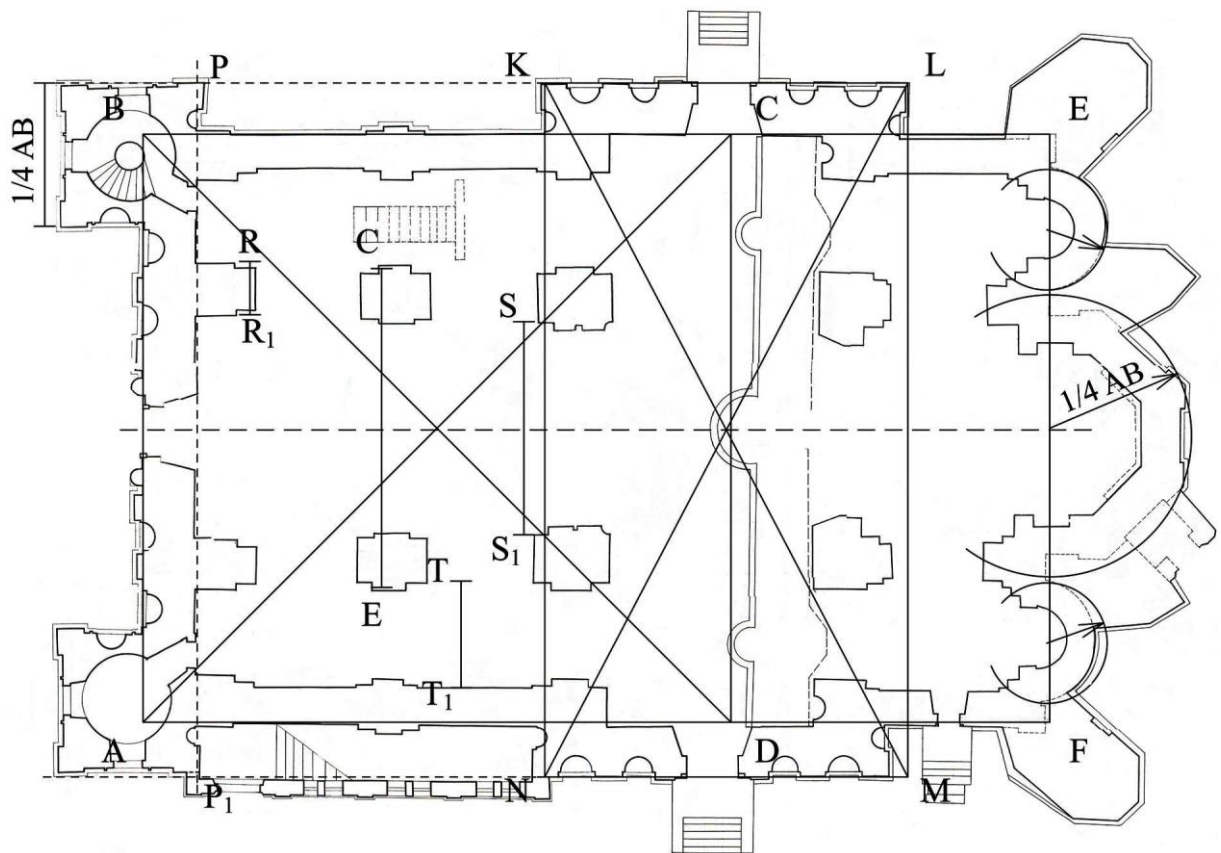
(продовження). Схема побудови плану Троїцького собору
